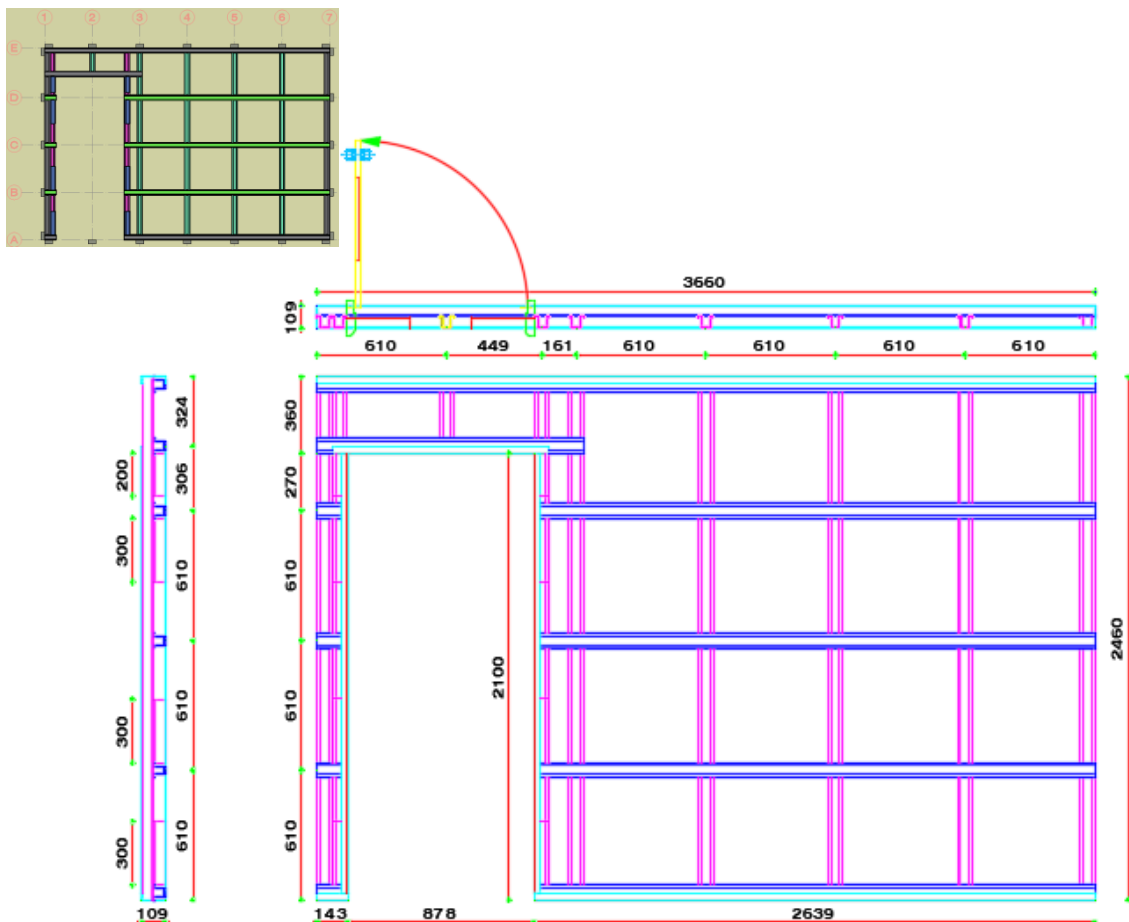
Dimensiones de panel puerta de 3.660mm x 2.460mm
